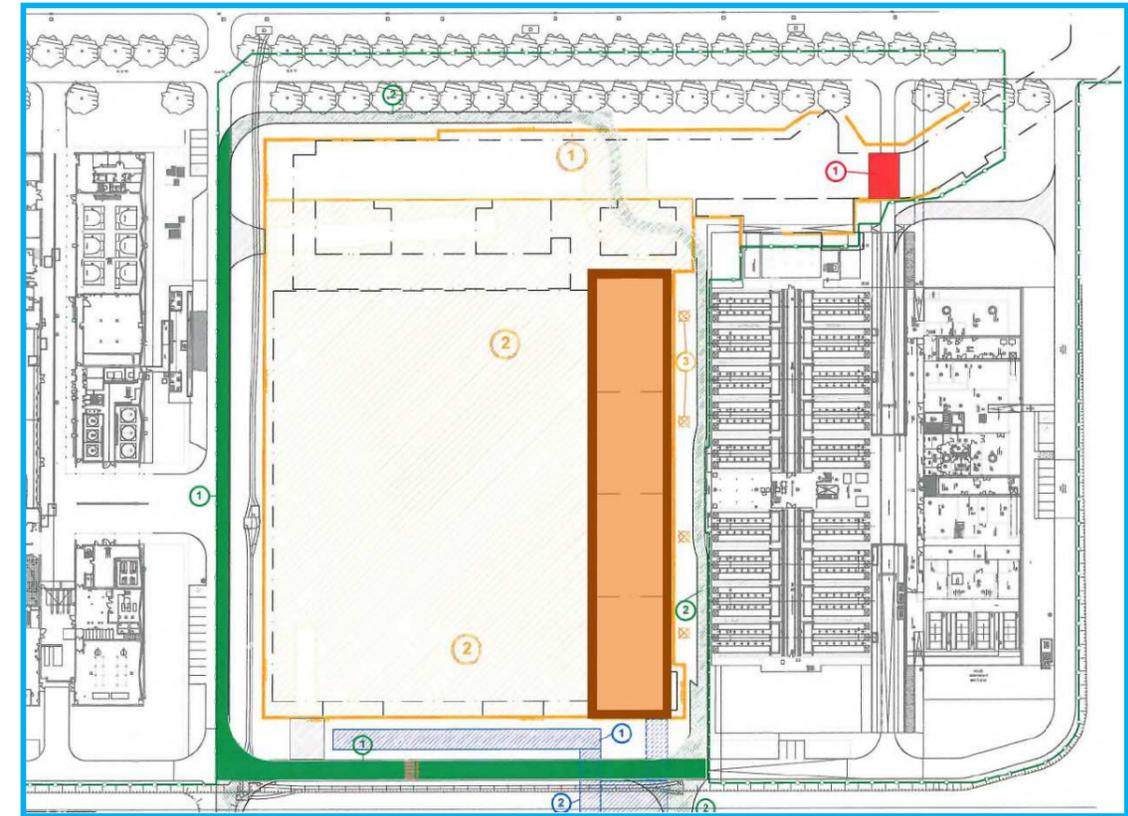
Emprise terrassée en zone biofiltration pour laquelle un rabattement est nécessaire
